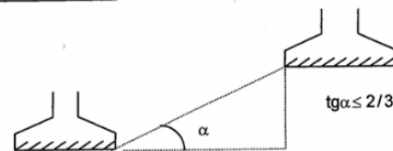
Schéma relatif aux fondations ancrées à des niveaux différents Source : NF P 94-261
